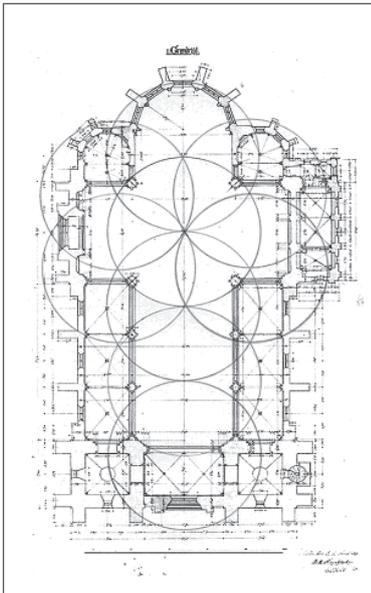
Blume des Lebens über dem Grundriss St. Ludgerus, Billerbeck
